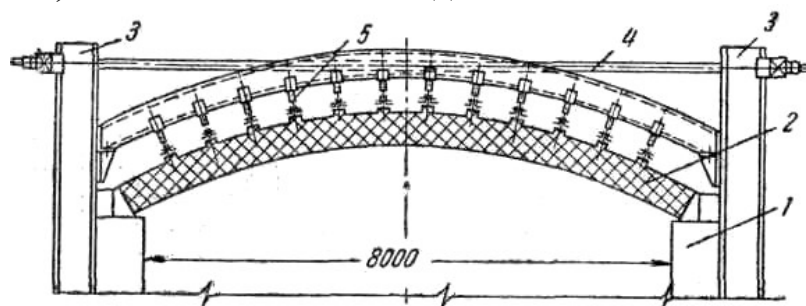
Распорно-подвесной свод отражательной печи: 1 – стены печи; 2 – арочный свод; 3 – стойки крепления; 4 – тяга; 5 – подвески свода
